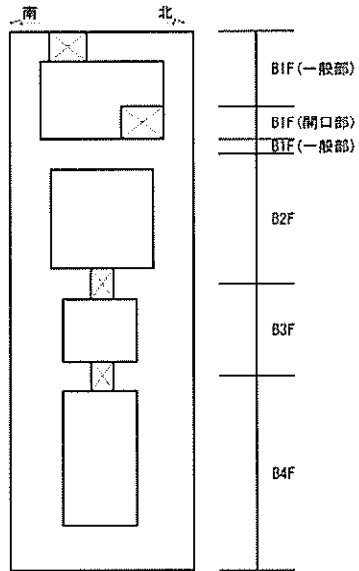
(3) 概略配筋図 (南北方向断面)
